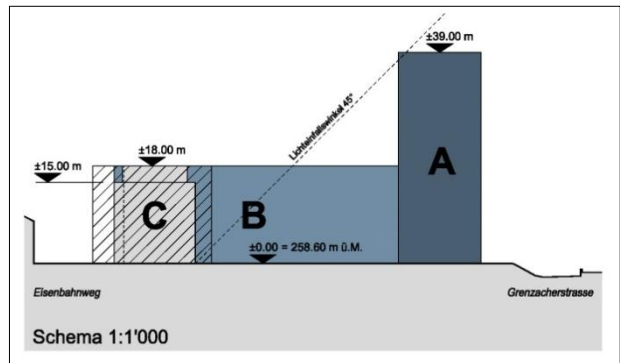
Neuer Bebauungsplan, Schema-Schnitt
